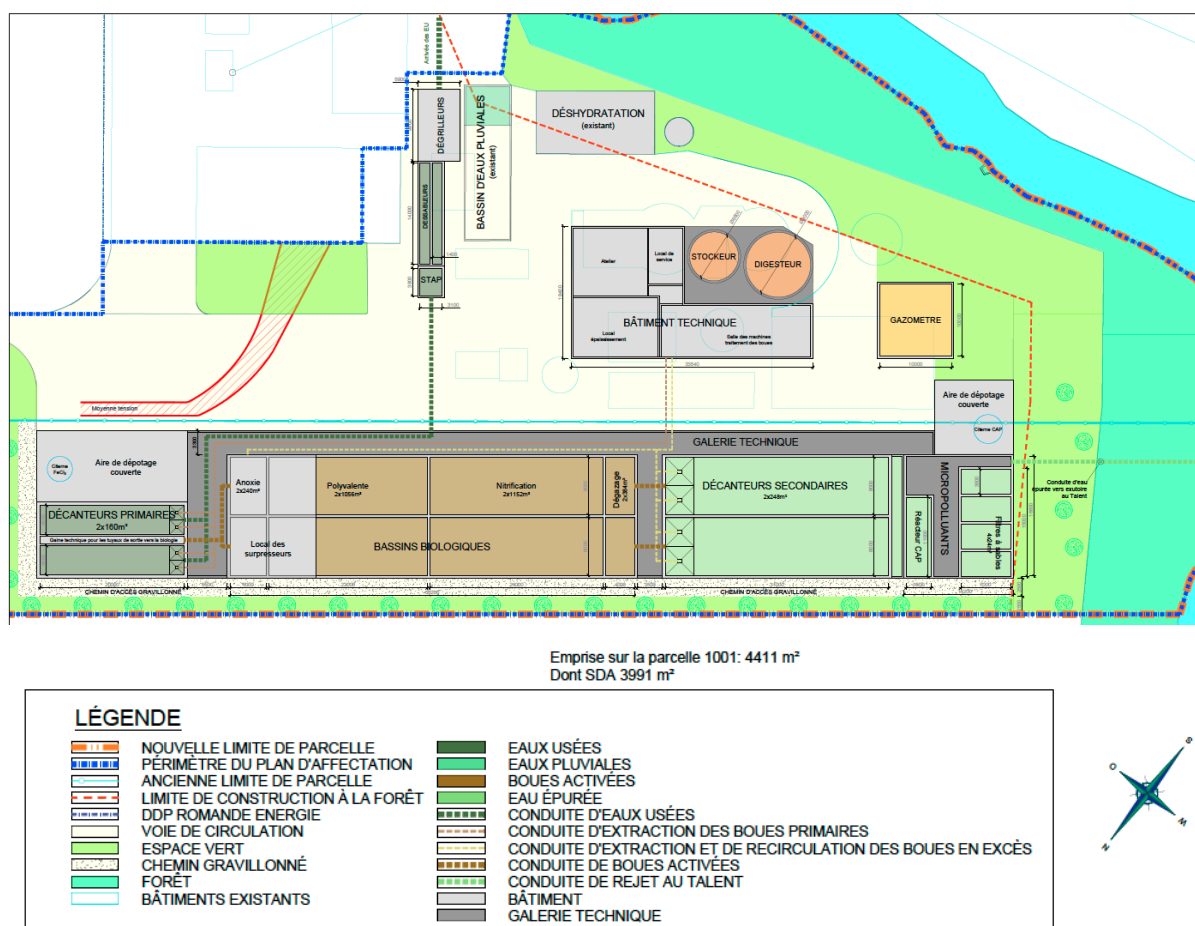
Implantation de la future STEP régionale sur le site d'Echallens
